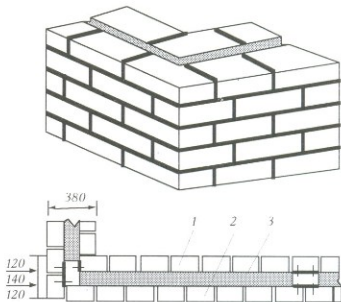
Схема комбинированной кладки стены: 1, 2 — кирпичная кладка; 3 — пенобетон
